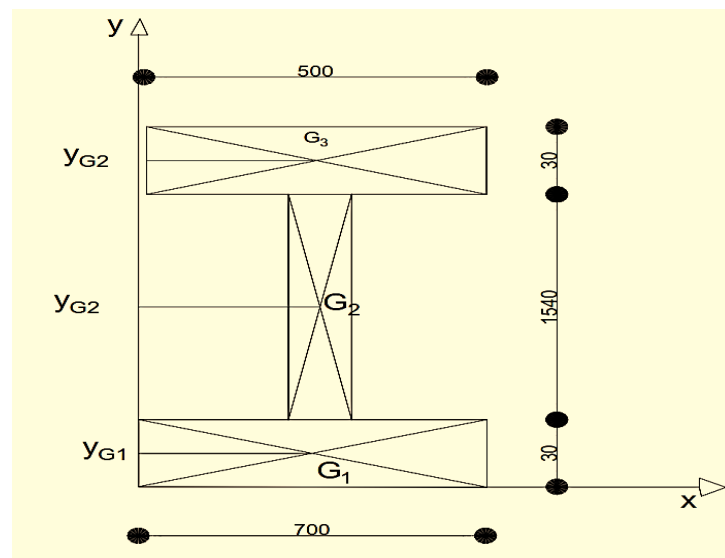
CENTRE DE GRAVITE DE LA POUTRE
